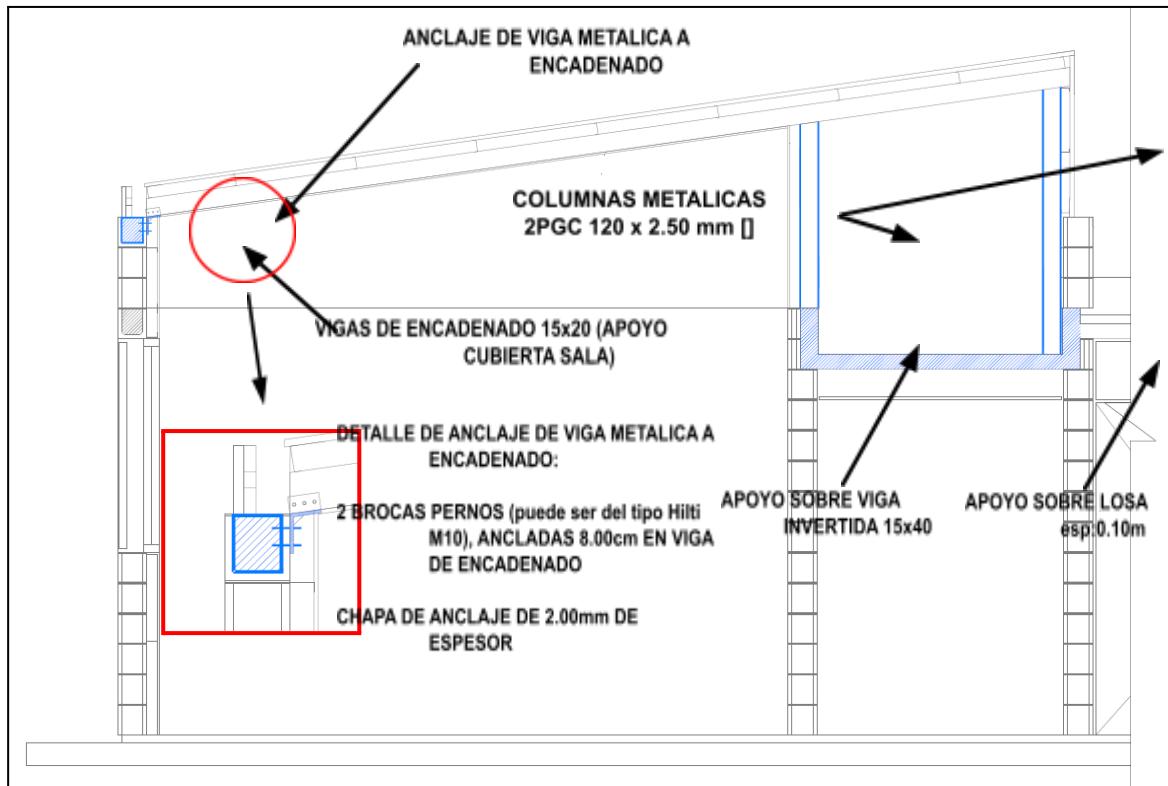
Esquema de secciones adoptadas para vigas de encadenado del sector Salas / Taller /Oficinas y Cocina.
